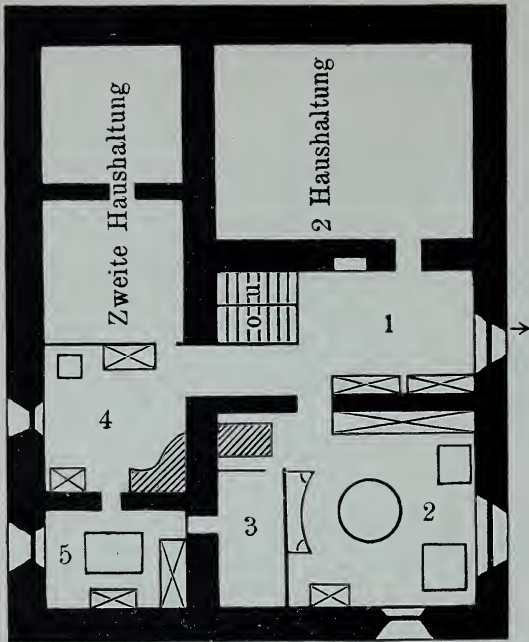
Flims. I. Stock (Eingang im Erdgeschoß) 3. Wohnstock (s. Grundriß),
